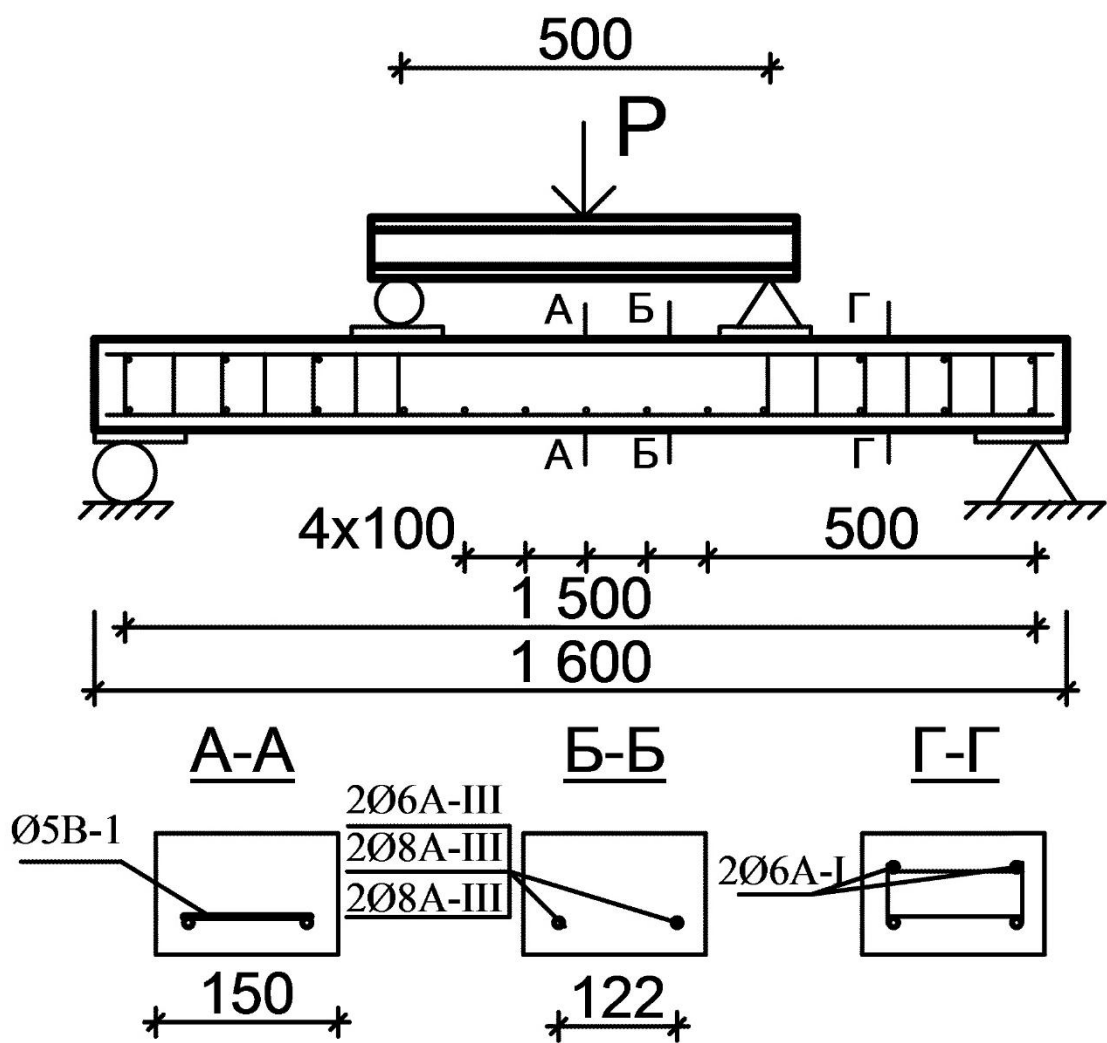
Проектные размеры и армирование опытных железобетонных образцов-балок Ерышева В.А.
